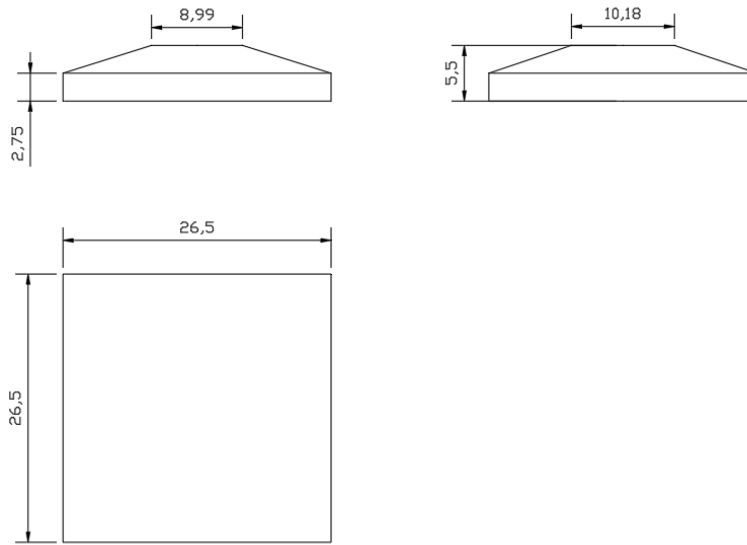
cimentación Pila 4. Alzado, planta y perfil
